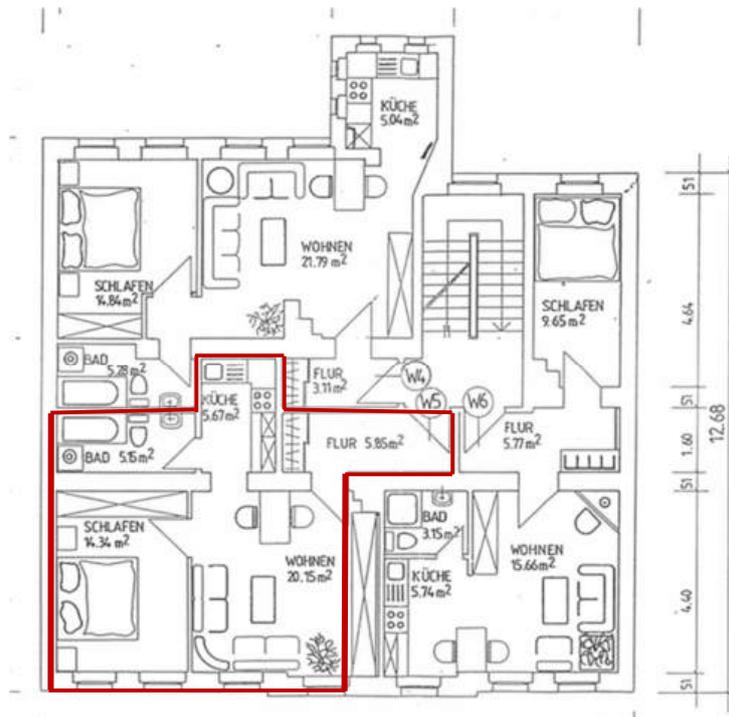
Grundriss Wohnung Nr. 5
